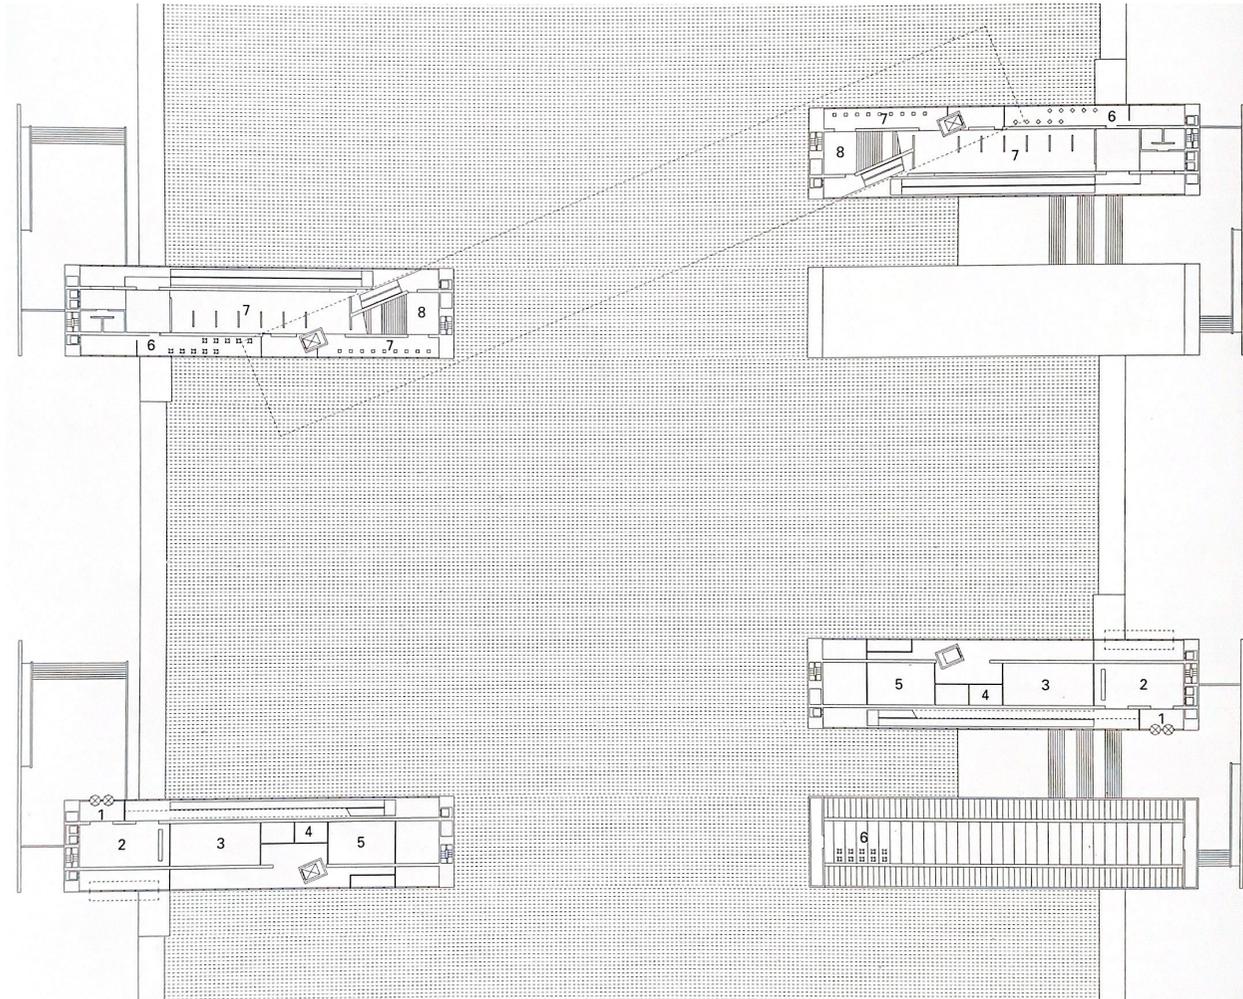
Planta primera (abajo) y planta segunda (arriba) del museo.
